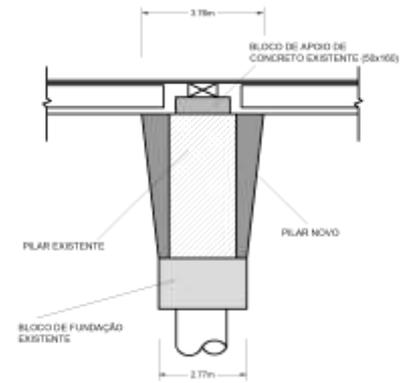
Cortes da estrutura do pilar do Viaduto após Retrofit, detalhamento do aumento de seção dos pilares e dos blocos de fundação. Fonte: Autoral.
